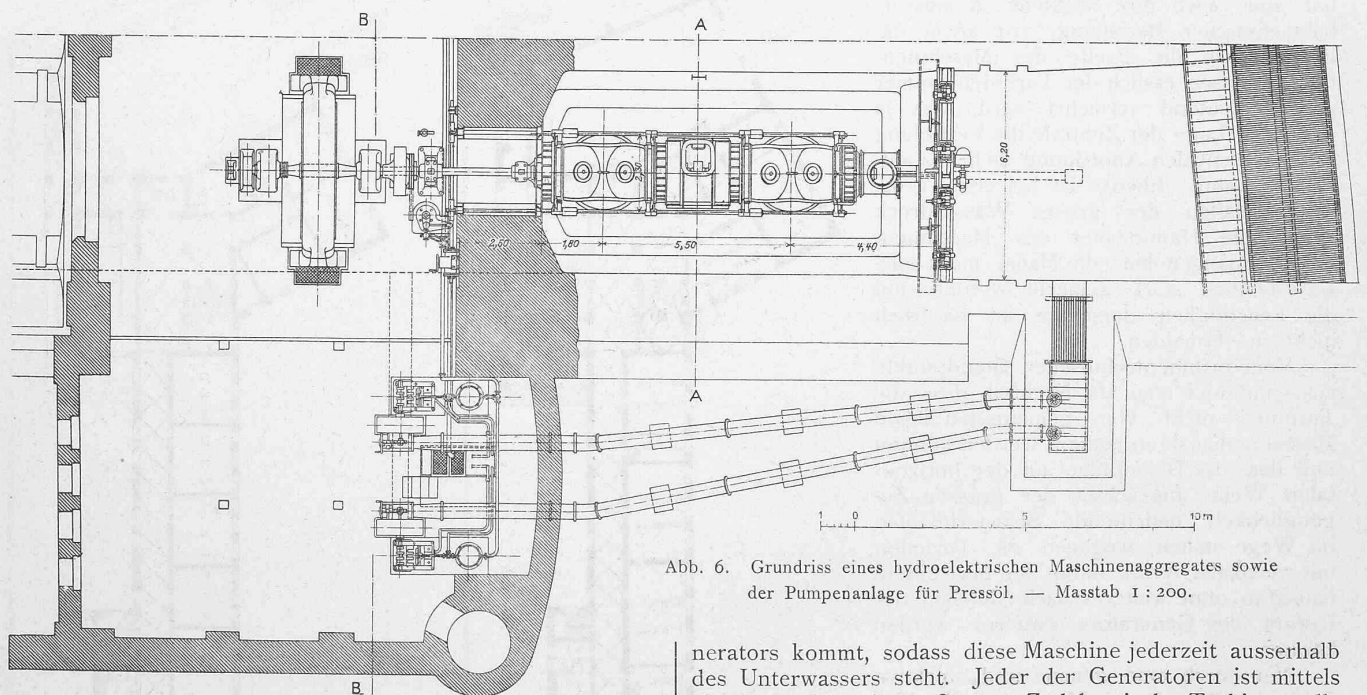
Grundriss eines hydroelektrischen Maschinenaggregates sowie der Pumpenanlage für Pressöl. — Masstab 1 : 200.
